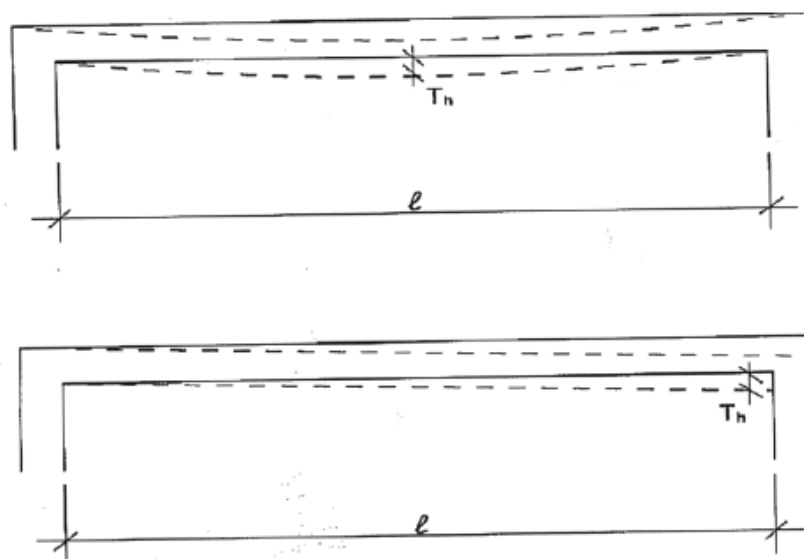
Tolerâncias para comprimento das paredes
